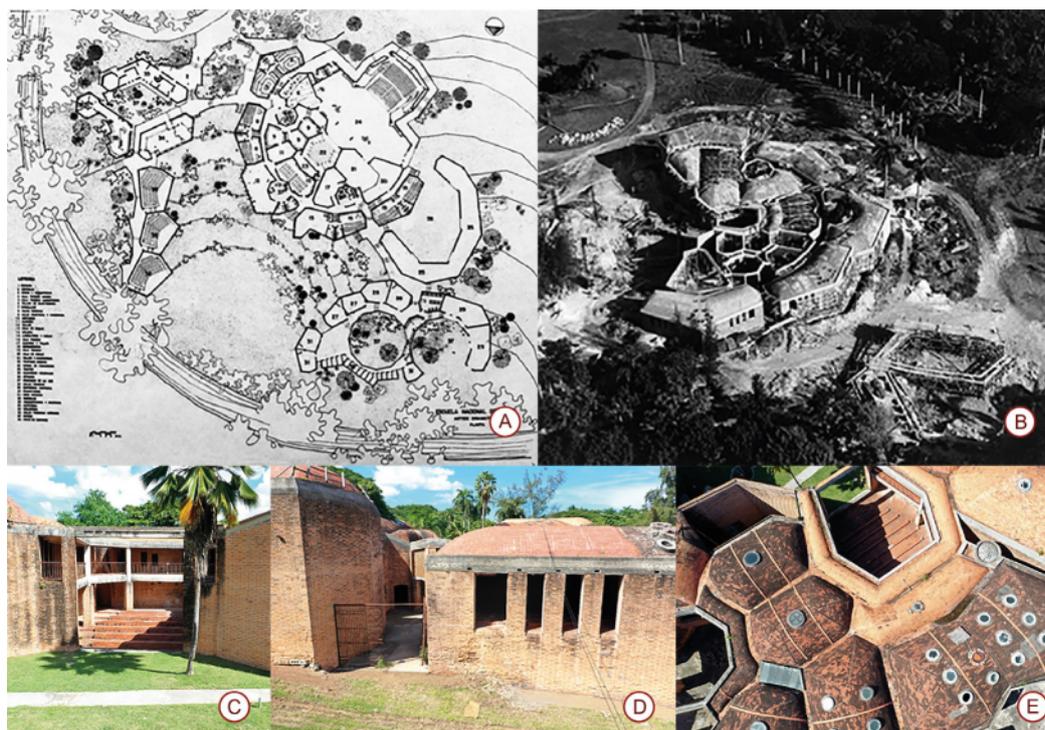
In ordine da sinistra a destra: planimetria di progetto originale (a); foto di cantiere (b); vista della corte interna dall'accesso principale (c); vista esterna di una porzione del complesso (d); veduta aerea del sistema di copertura con volte tabicadas (e).
